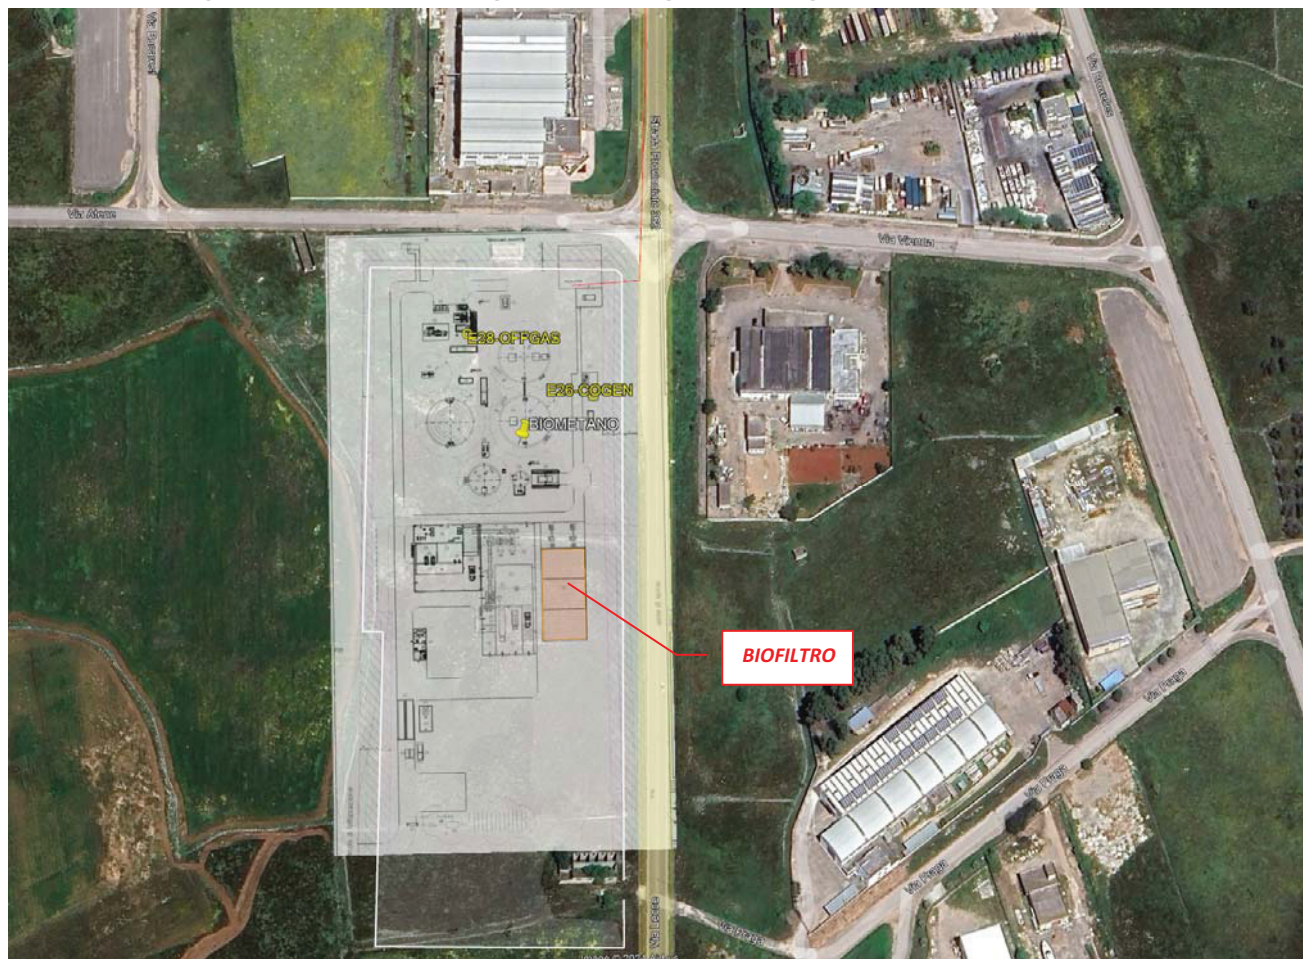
Planimetria su ortofoto 23.05.2023 GE- si indicano le fonti di emissione presenti nell' installazione in progetto
